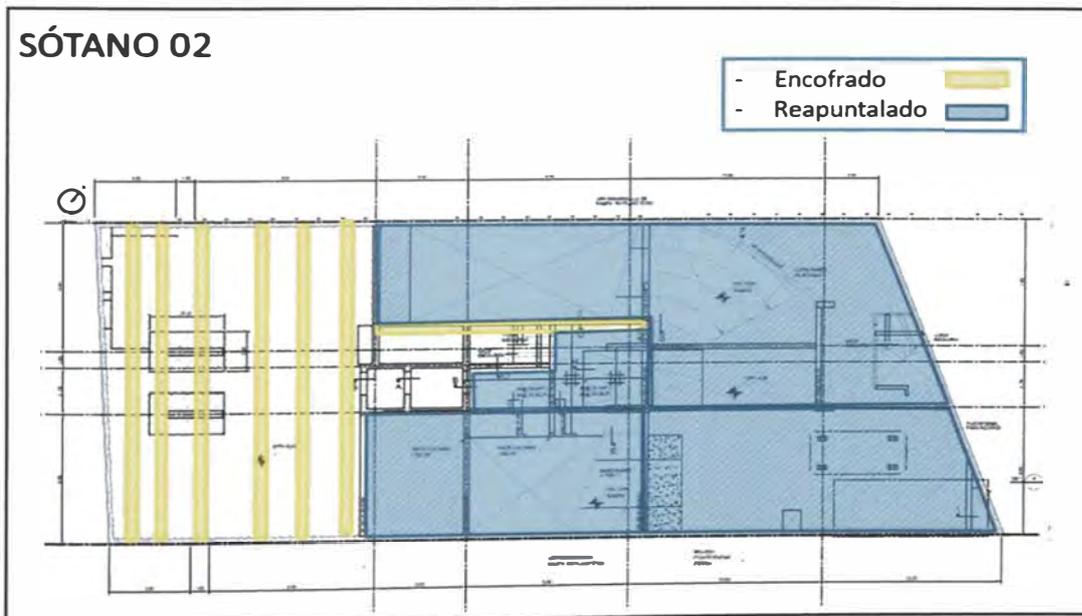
Material de encofrado y reapuntado en la Losa del Techo Sótano 02
